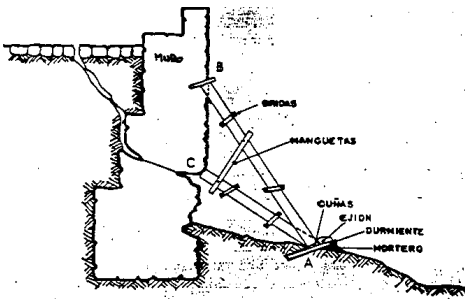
Detalle apeo cimentación. Broto, Apeo cimentación.
